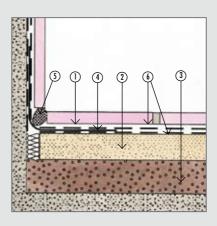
Pose de carrelage sur Knauf Sol avec Knauf Étanche et Knauf Bande
